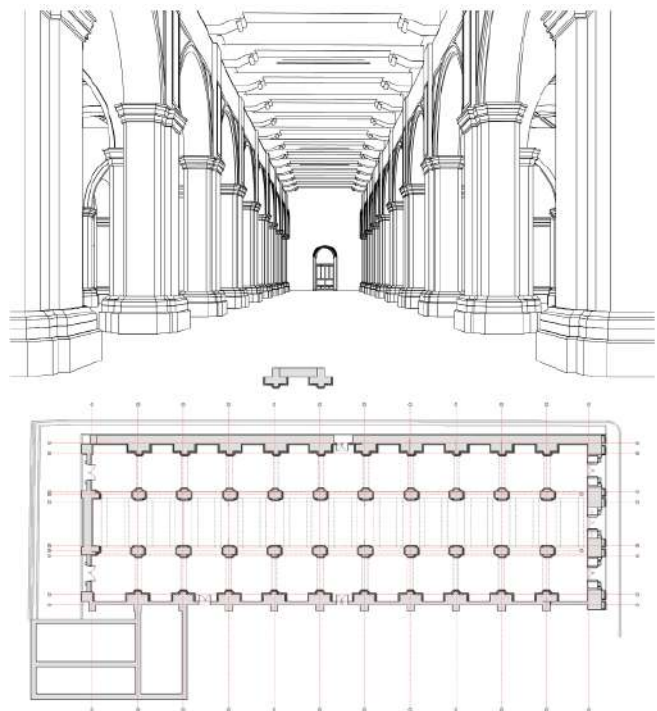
Reconstrucción de planta y espacio interior de la catedral del siglo XVIII.
